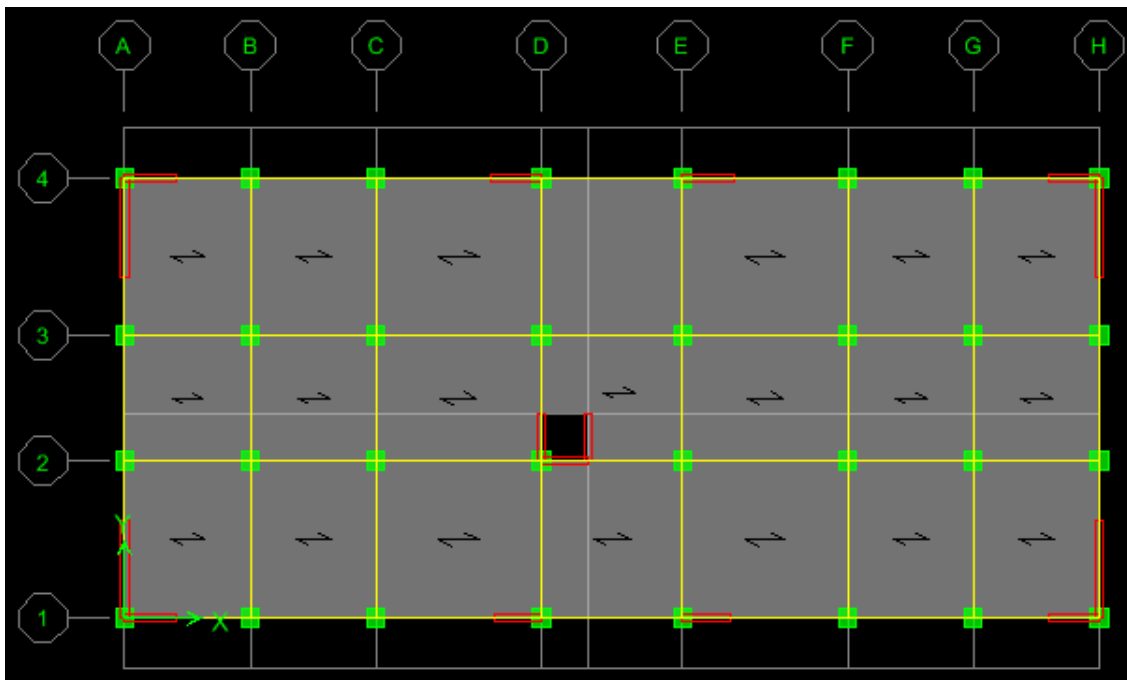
Vue en plan des éléments structuraux d'un étage
